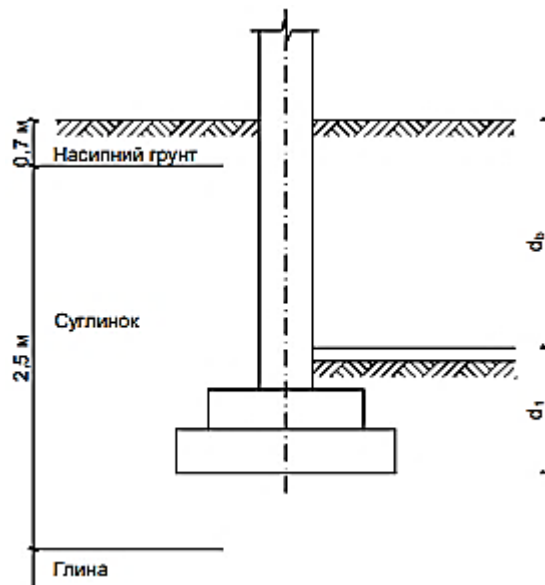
Схема розміщення фундаменту у ґрунті
